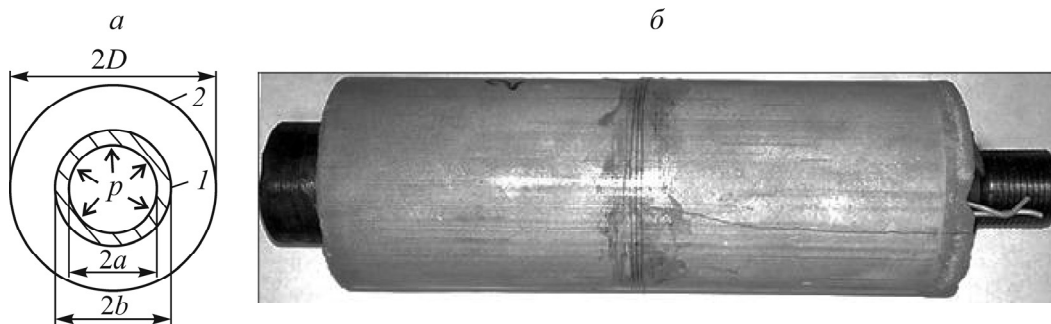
Образец для испытаний под давлением (а): 1 — стальная труба; 2 — цементная труба; составной образец — вид сбоку (б)
